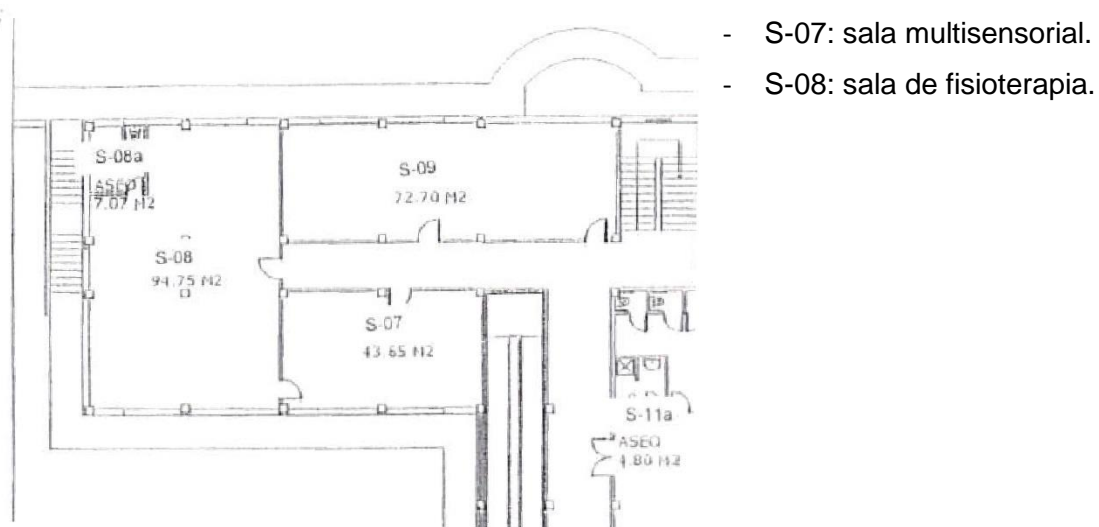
Detalle Plano Sótano. Fuente: documentos del centro.
